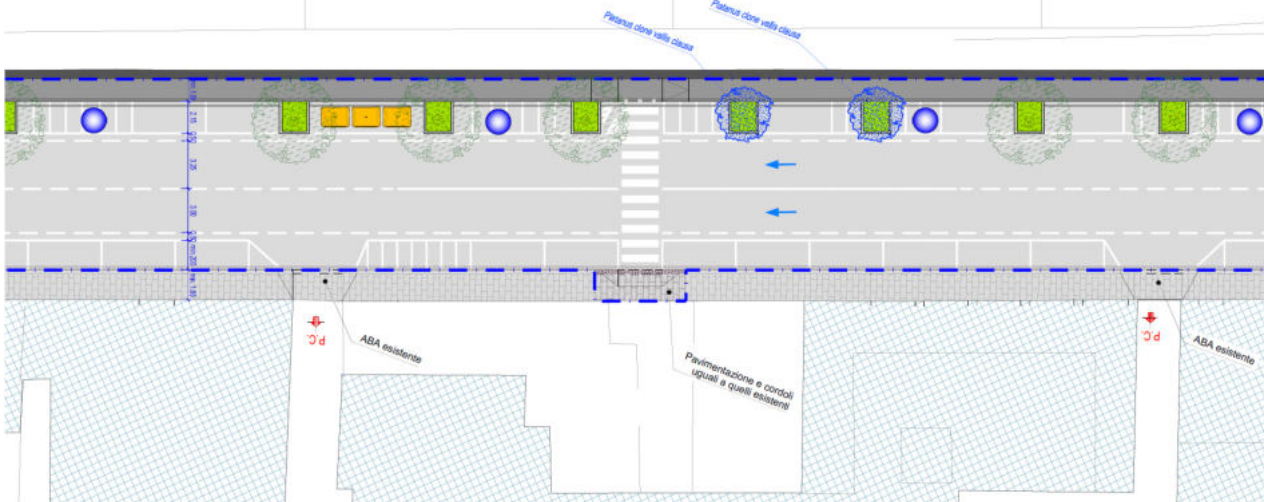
Progetto Esecutivo – Stralcio planimetrico di viale G. Milton
